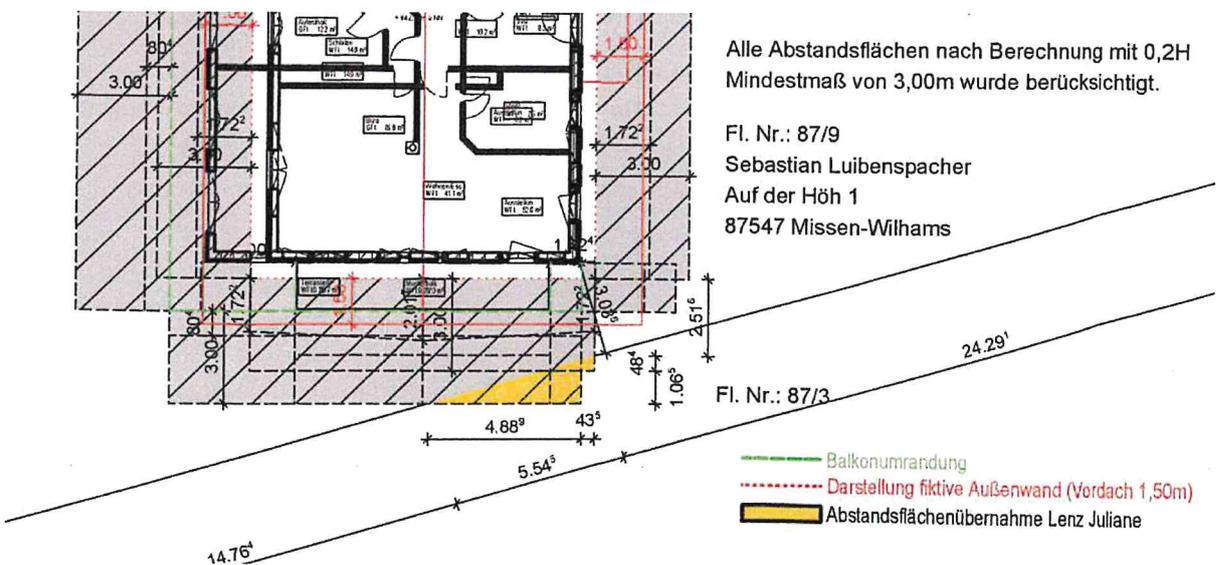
Im Rahmen der Bebauung des nördlich angrenzenden Grundstücks wurde eine Abstandsflächenübernahme auf das hier zugrundeliegenden Plangebiet vereinbart.
